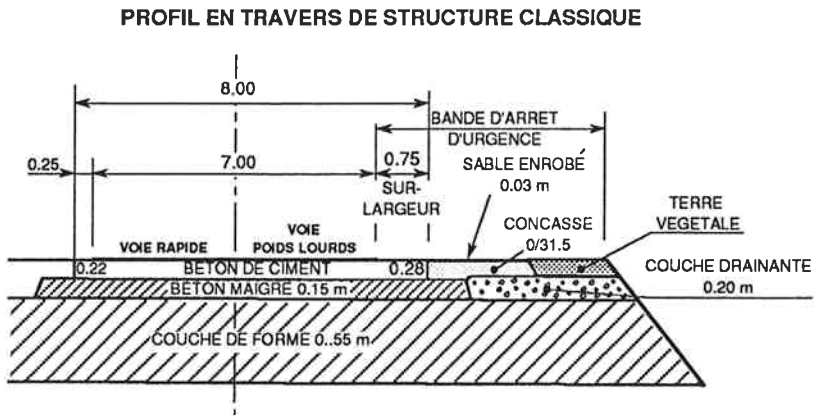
Profil en travers type d'une chaussée en béton
